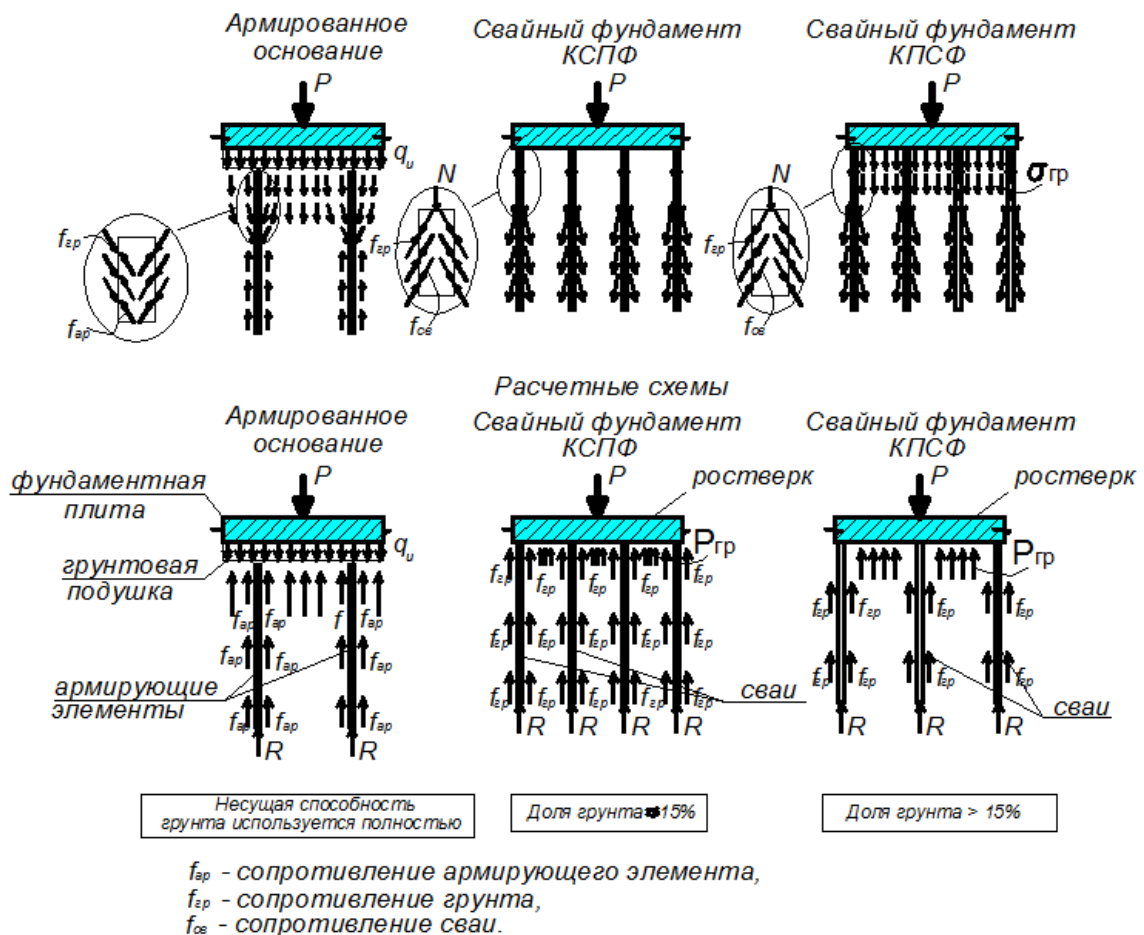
Схемы передачи нагрузки на армированное вертикальными элементами грунтовое и свайное основание
